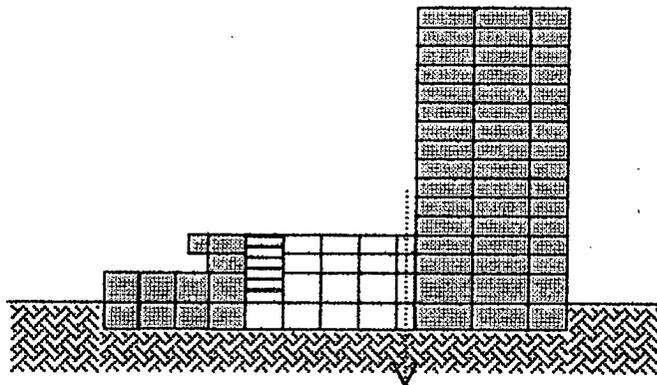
Torre de oficinas separada sísmicamente de la estructura de estacionamiento del edificio. Edificio Kaiima International. Los Angeles.
